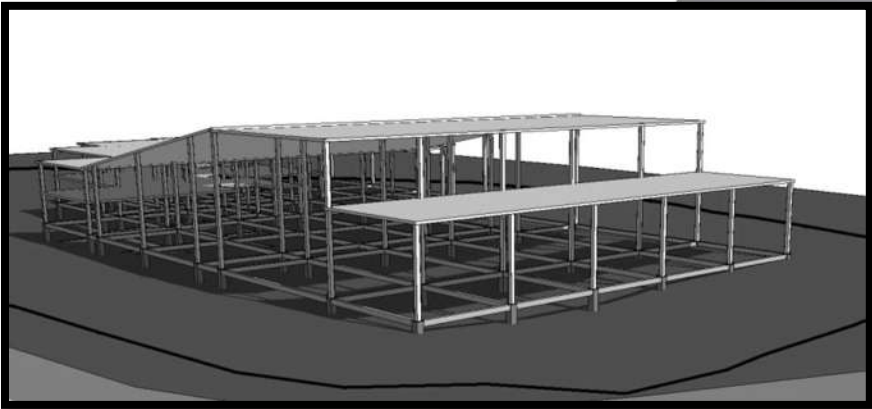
Volumetría de terreno con red de zapatas aisladas, trabes de liga y cubiertas. Fotografía digital tomada desde el noreste.
